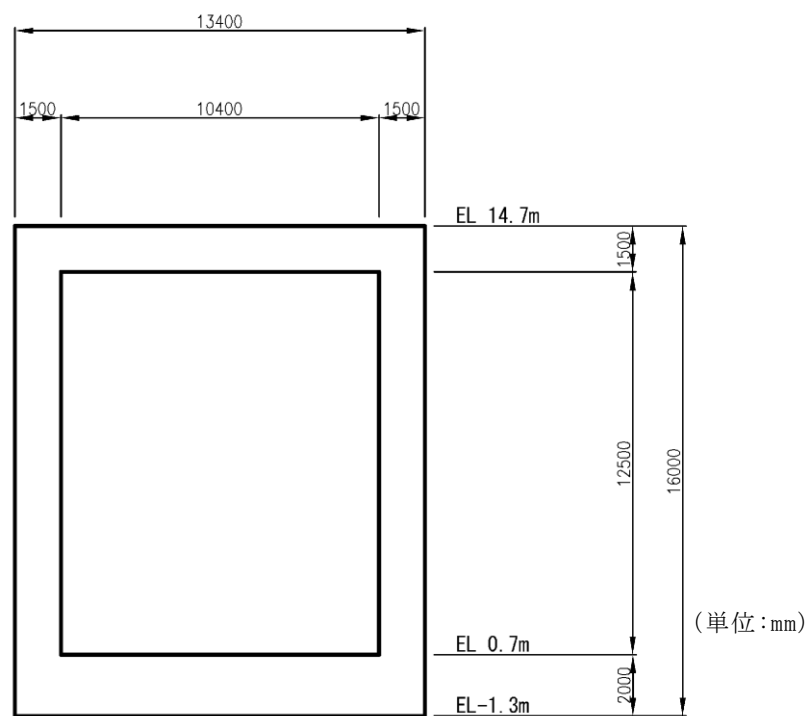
低圧原子炉代替注水ポンプ格納槽 断面図 (B-B 断面)
